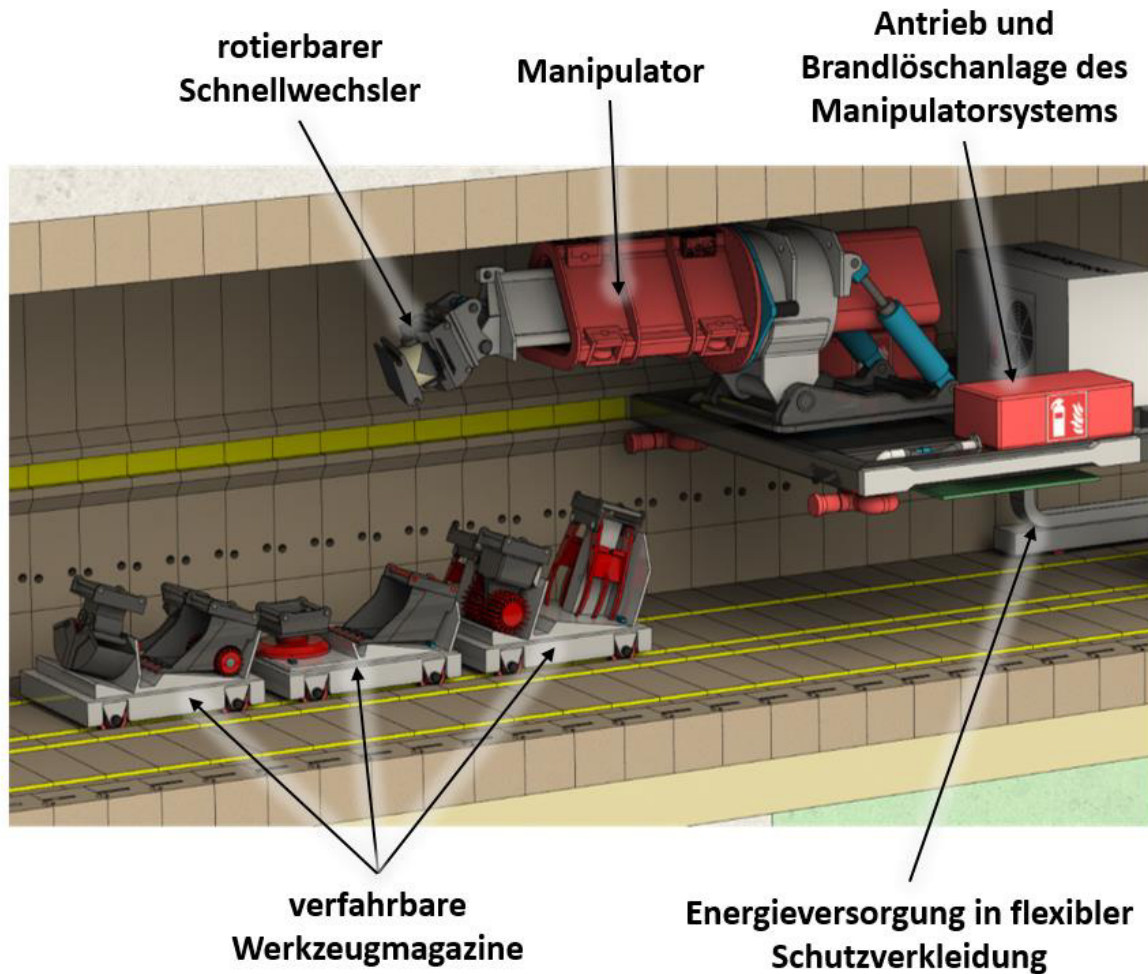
Rotierbarer Schnellwechsler am Manipulatorsystem und Werkzeugmagazine
